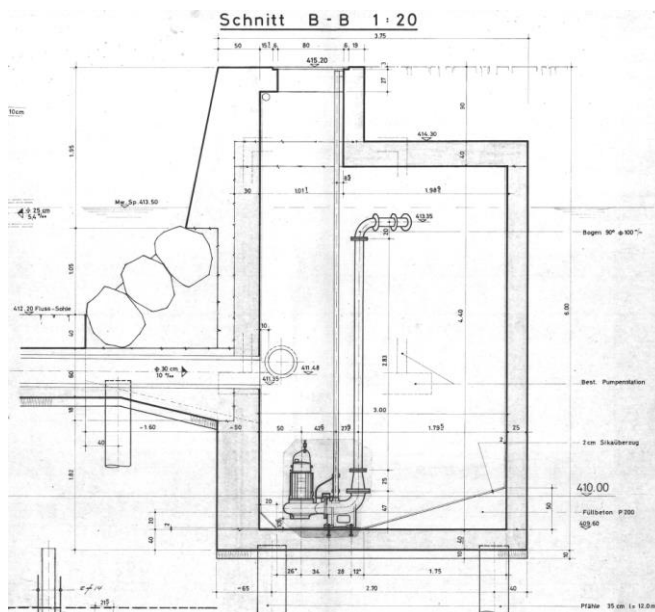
Auszug Plan «Korrektion der Lorze – Bauprojekt 1969», Neuer Pumpenschacht, Schalungsplan)
